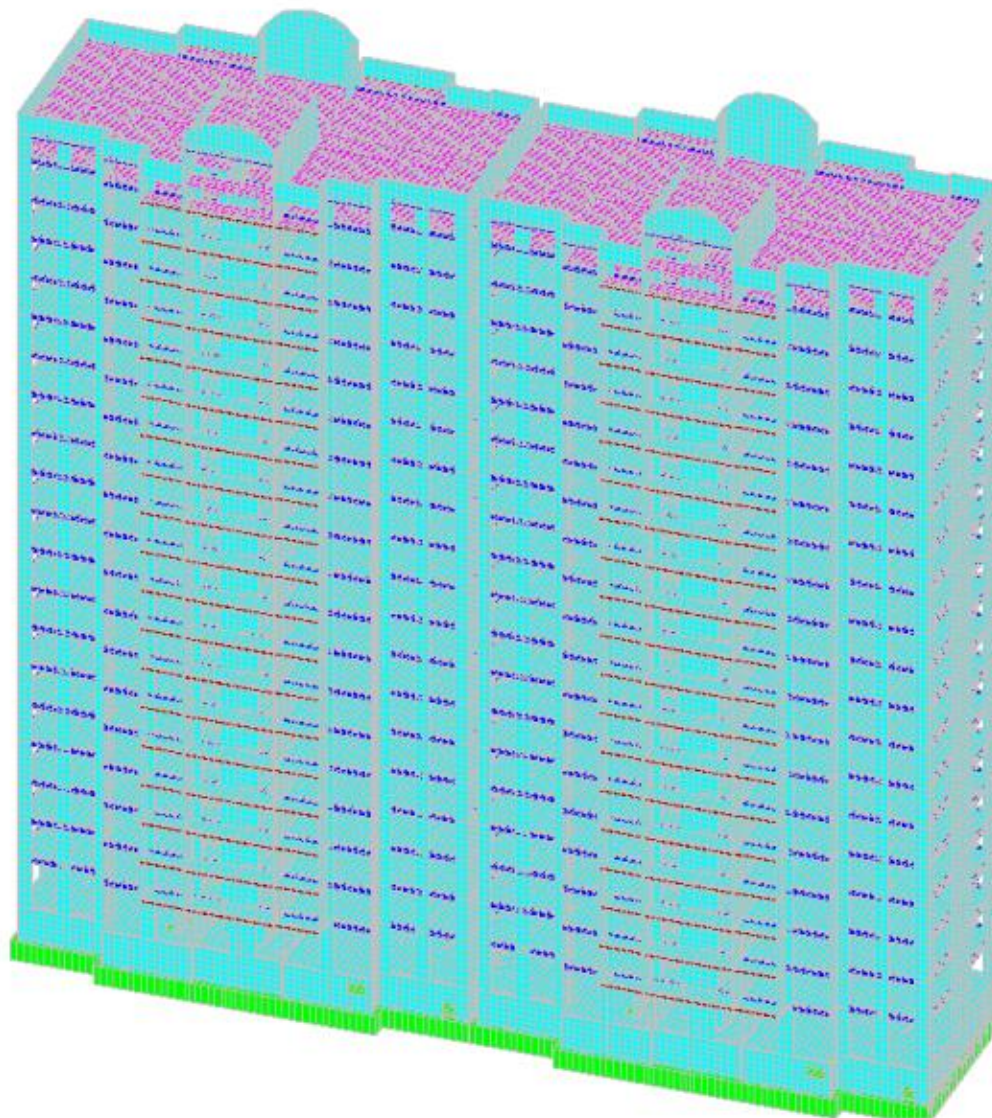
Расчетная модель здания на фундаментной плите в ПК SCAD
